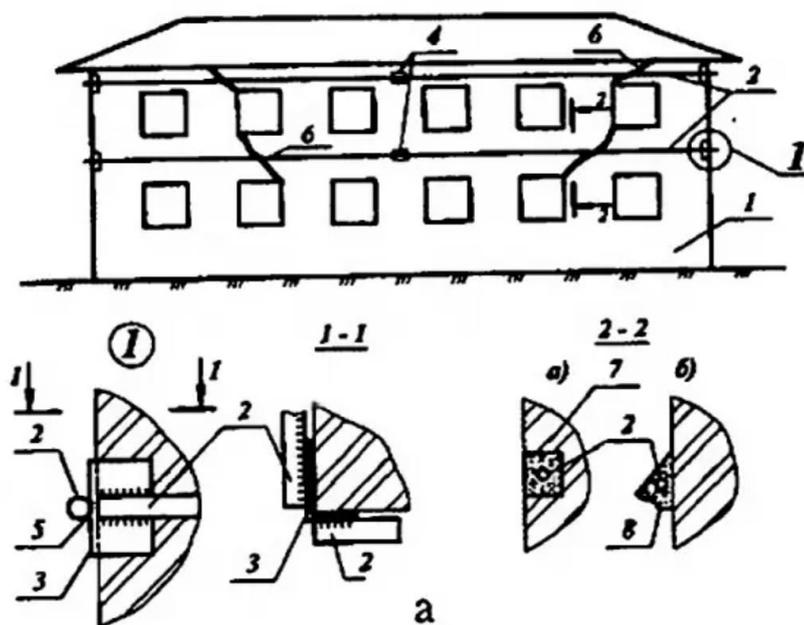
Усиление кирпичных стен тяжами с наружной стороны стен [1]; 1 – деформированное здание; 2 – стальные тяжи; 3 – отрезки стальных прокатных уголков; 4 – стяжные муфты; 5 – сварной шов; 6 – трещины в кладке стен; 7 – штраба в стене для тяжа; 8 – промежуточный карниз из ц/п раствора
